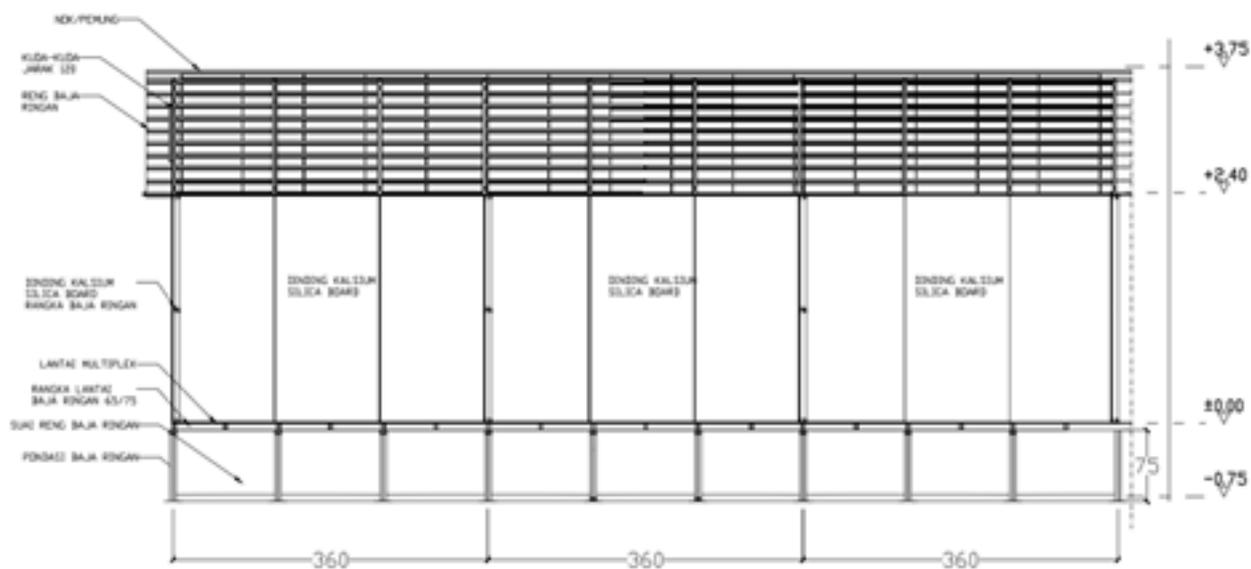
Detail Denah Rancangan Model Huntara Komunal
